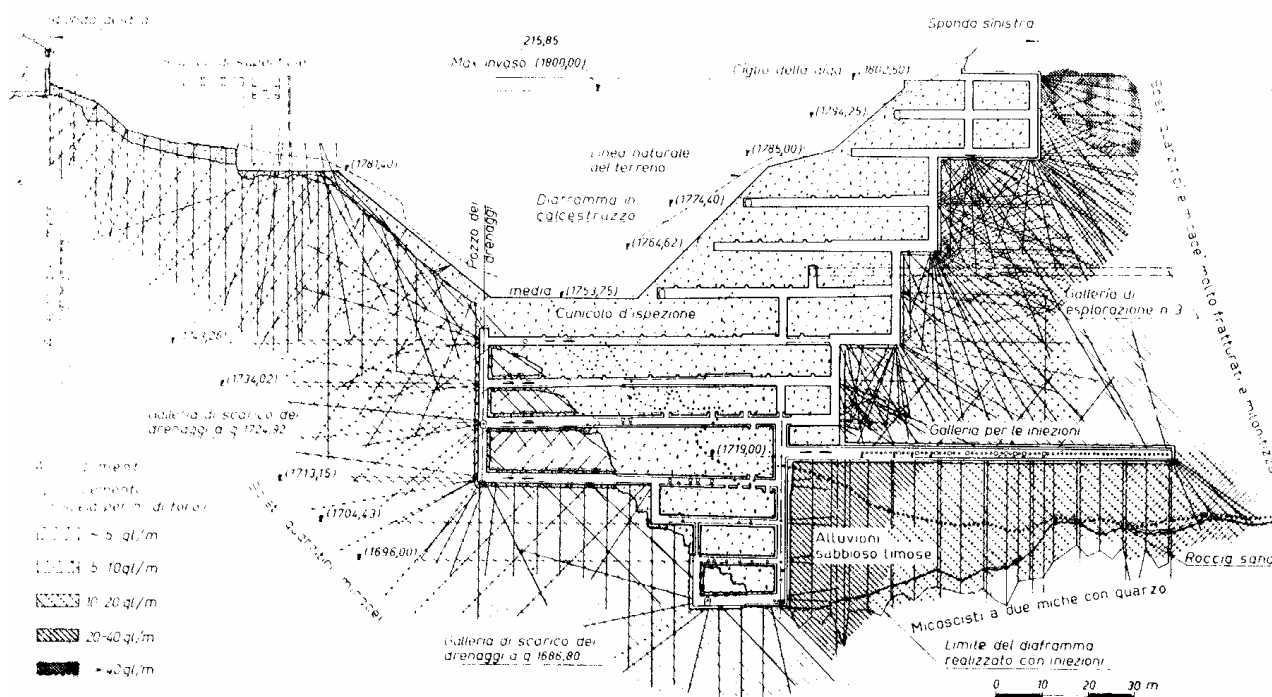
Diga in blocchi di calcestruzzo di Pian Palù (1950-59): schermo di impermeabilizzazione delle fondazioni.
